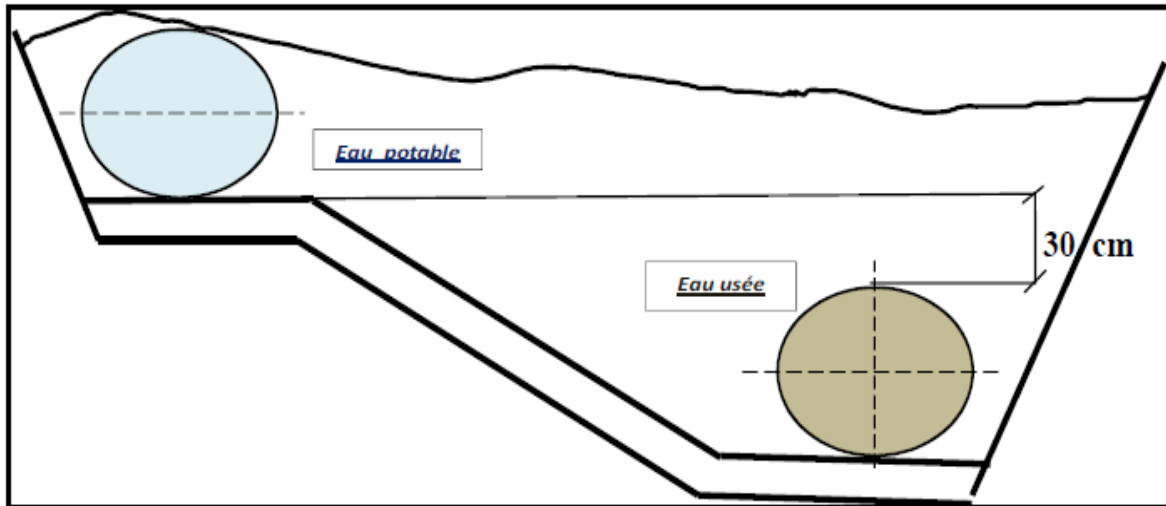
Pose à proximité d'une conduite d'assainissement.
